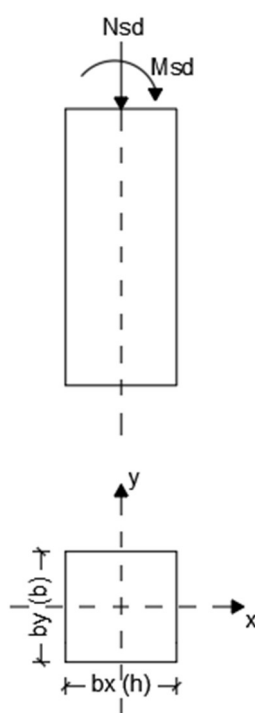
Representação esquemática de ações e seção do pilar.
